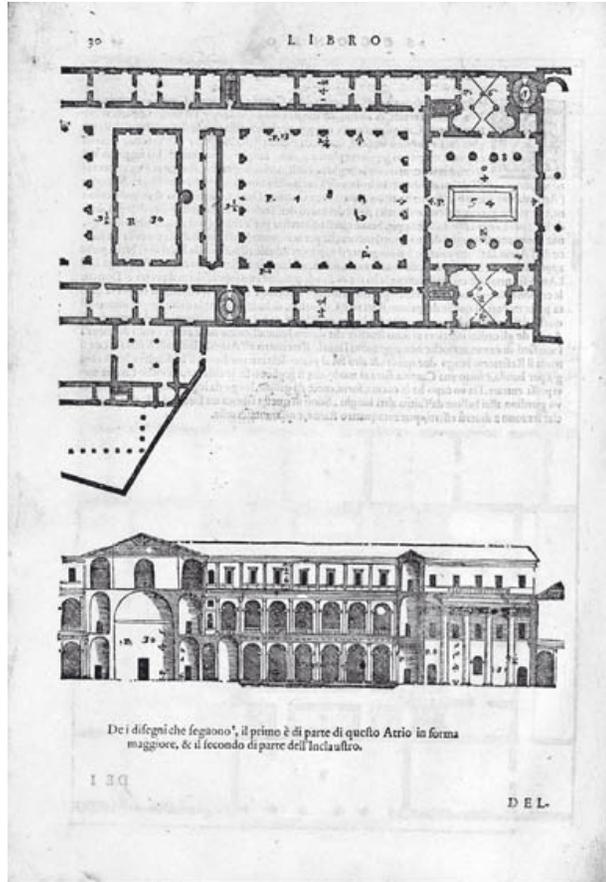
Convento della Carità, Längsschnitt und Grundriss;
